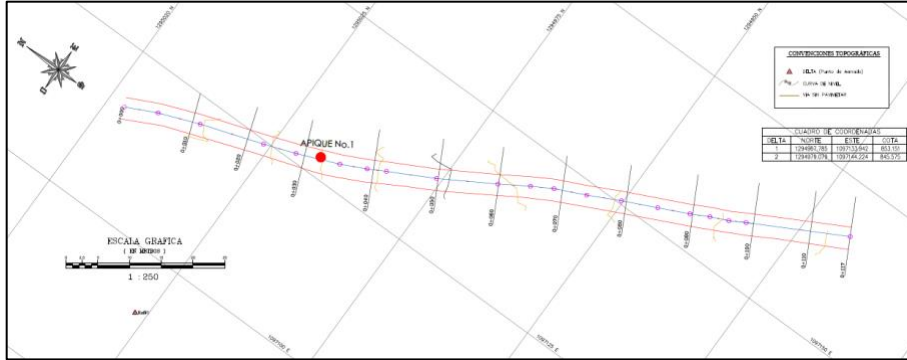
Imagen de planta del tramo 8 del proyecto de Rionegro-Santander
